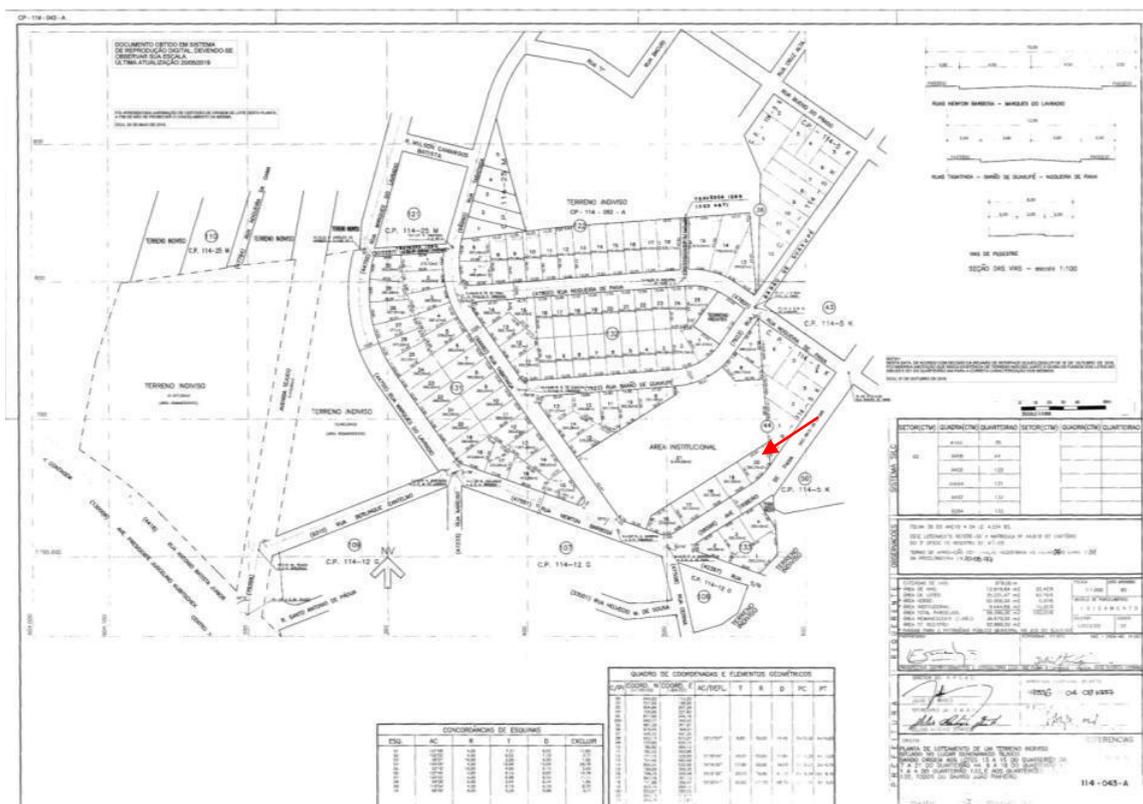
Planta de aprovação de loteamento no Alto dos Pinheiros, 1997. Planta CP-114-043-A. Disponível em: <https://siurbe.pbh.gov.br>. Acesso em 13 de junho de 2023.
